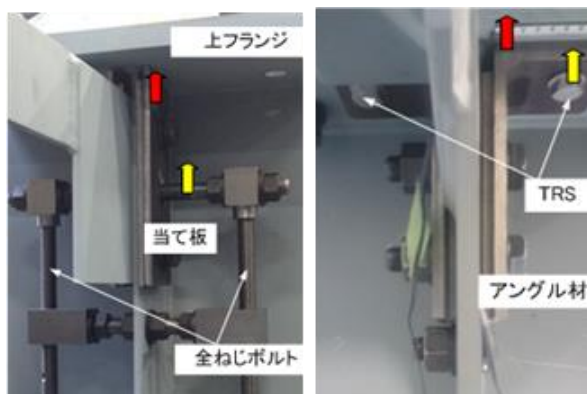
ジャッキアップによる 当て板施工状況 写真-2 TRSによる 当て板施工状況
